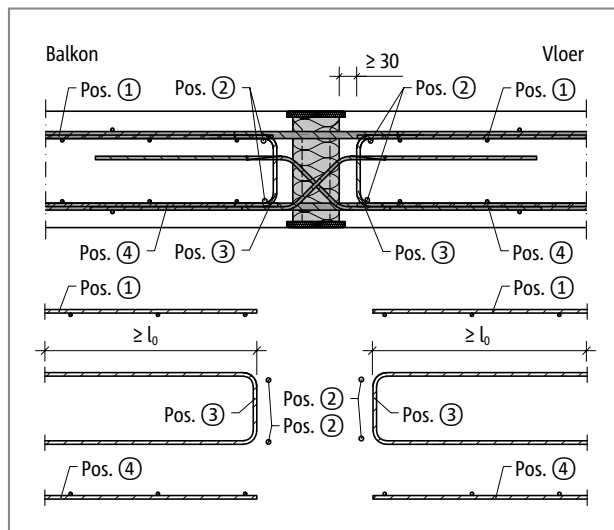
Schöck Isokorb® T type D bij RO: Zijaanzicht
